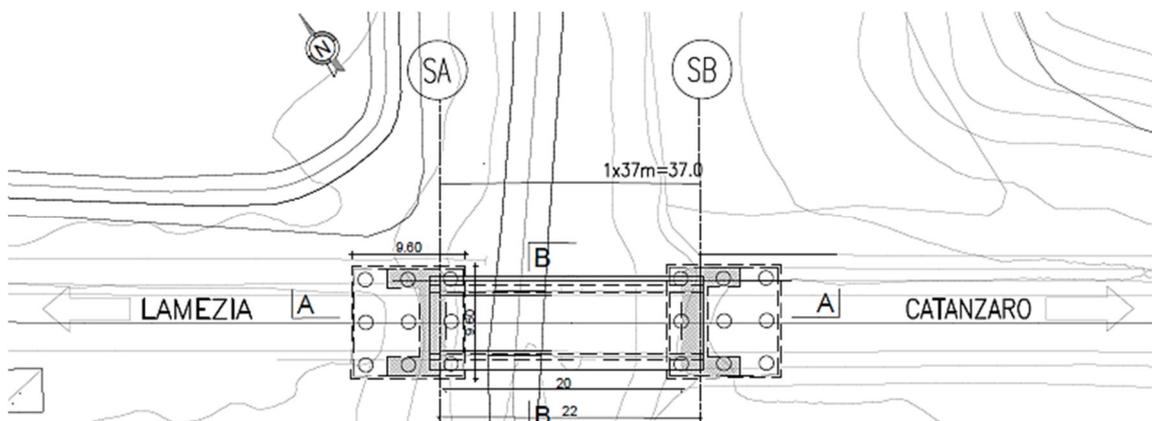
Planimetria tipo del viadotto ferroviario (VI04, VI05, VI07)
